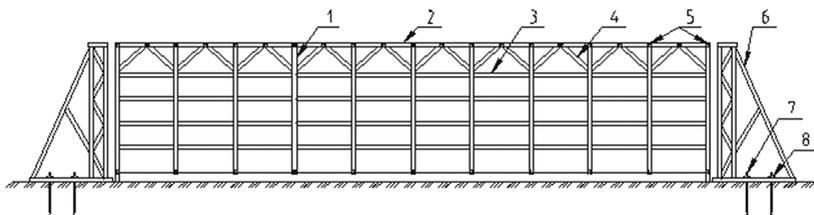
Продольный разрез базового блок-модуля с элементами усиления: 1 — вертикальные стойки; 2 — наружный профлист; 3 — горизонтальные балки; 4 — наклонные балки; 5 — поперечные балки усиления перекрытия; 6 — контрфорсы; 7 — анкера; 8 — гайки
